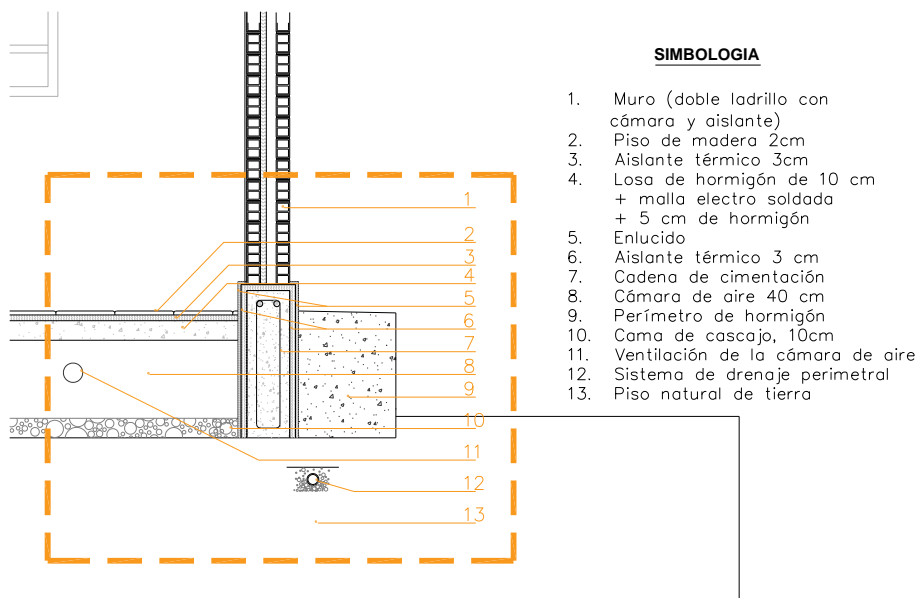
Propuesta, detalle del aislamiento del piso y la losa.
